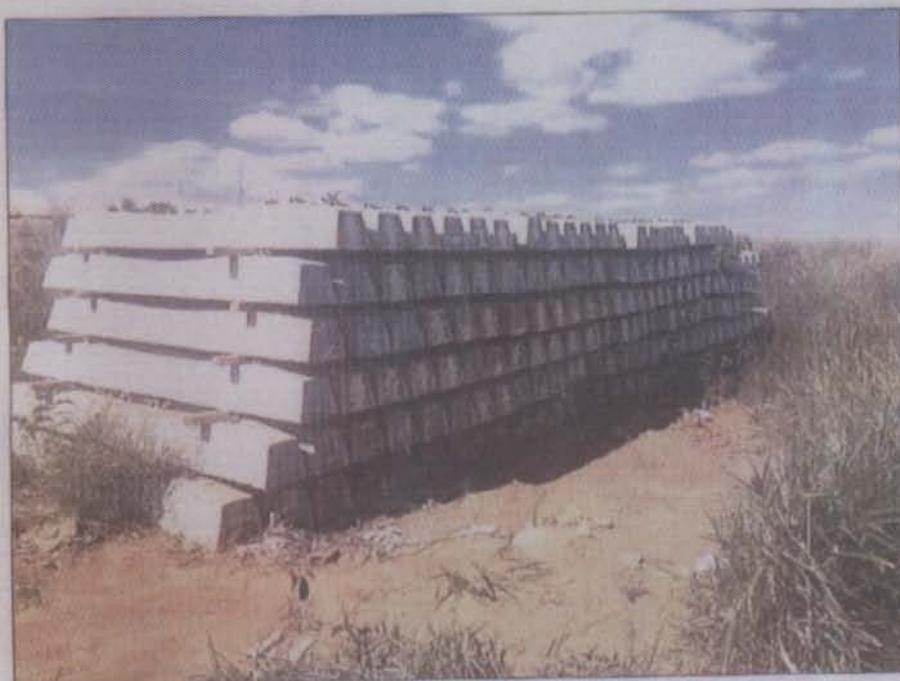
Dormentes de concreto armazenados no Pátio de Uruaçu.
